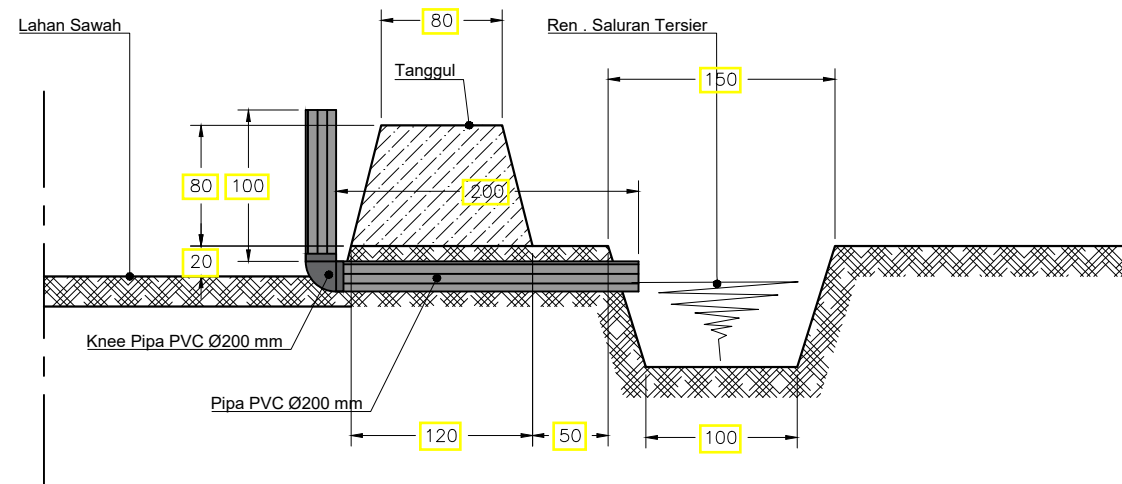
DETAIL TANGGUL & SAL. TERSIER (DETAIL 1)
